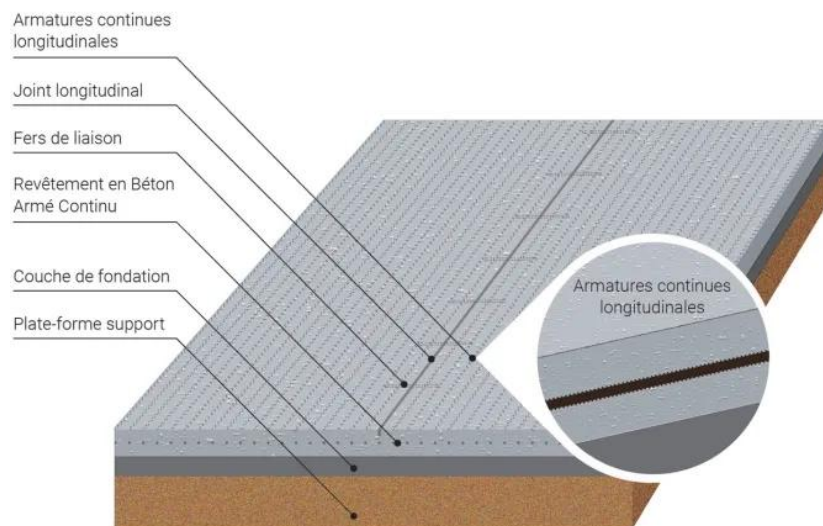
Disposition des aciers longitudinaux dans les chaussées en béton
